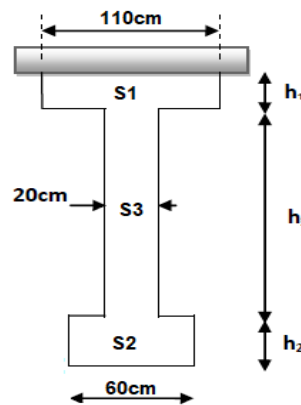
31 : La section homogénéisée de la poutre en section médiane
